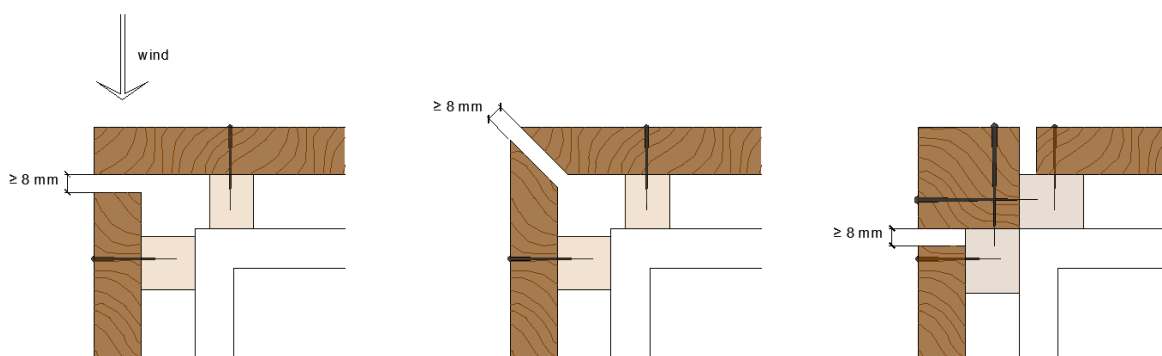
De voeg tussen de planken moet breder zijn dan 8mm, om capillaire opzuiging te vermijden.
